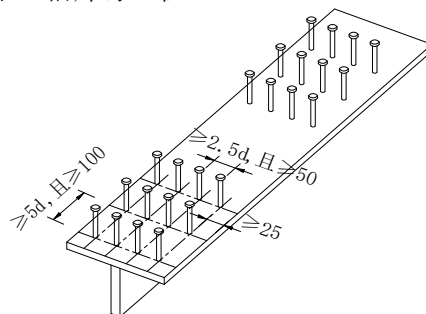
集簇式焊钉连接件示意图 (单位: mm)
